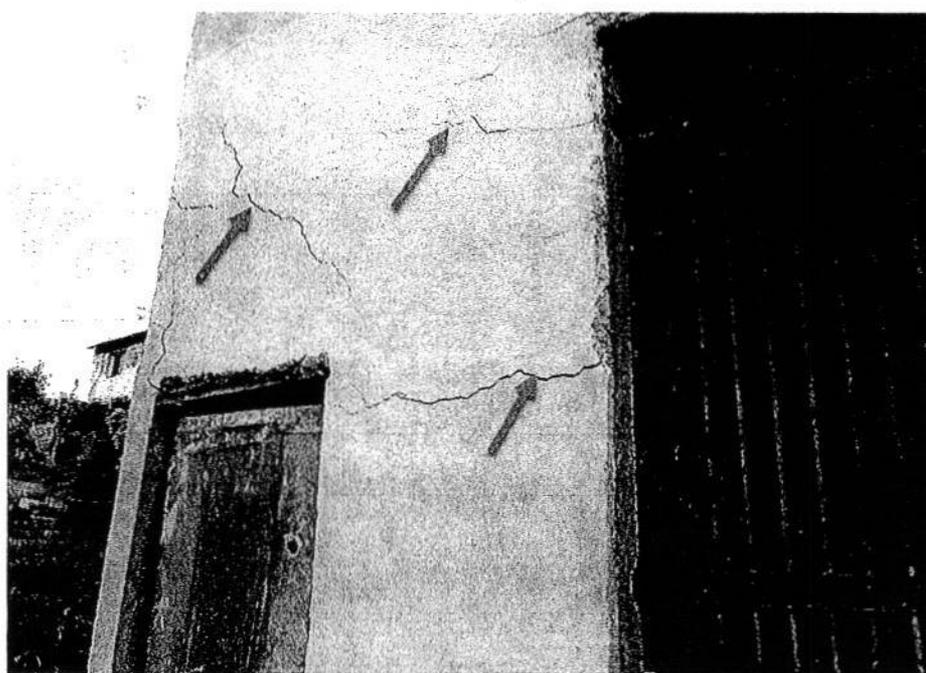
Fissuras e trincas na alvenaria da fachada.
